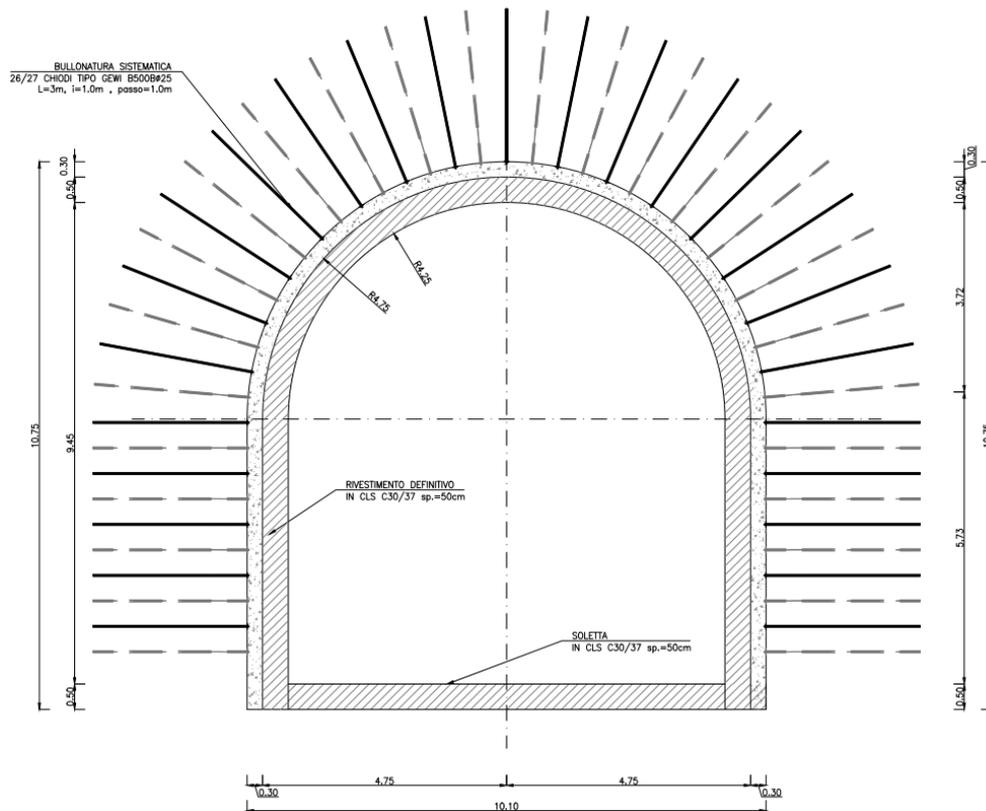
Sezione tipo della galleria d'accesso al pozzo paratoie
